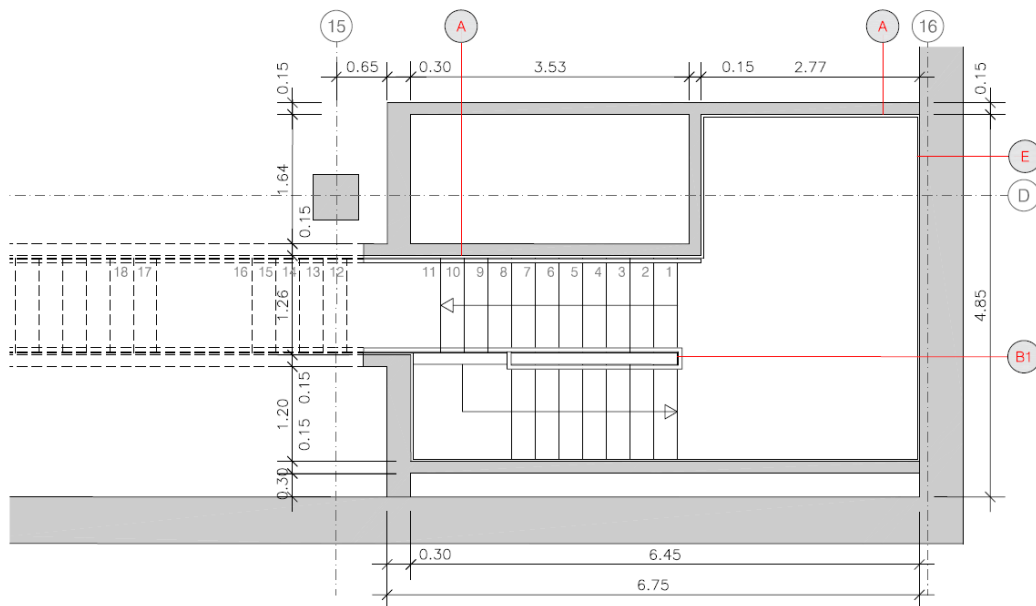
Diseño del nuevo acceso de peatones – Vista en planta
